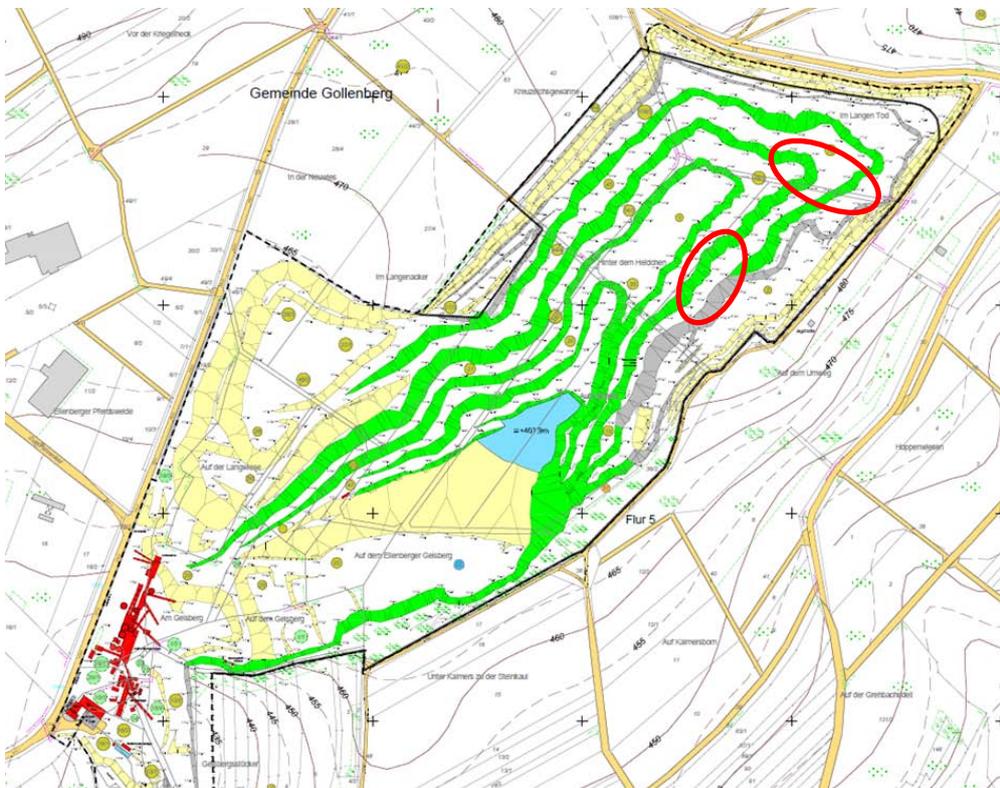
Lageplan mit Eintragung der Vernässungsstellen (o.M.)
